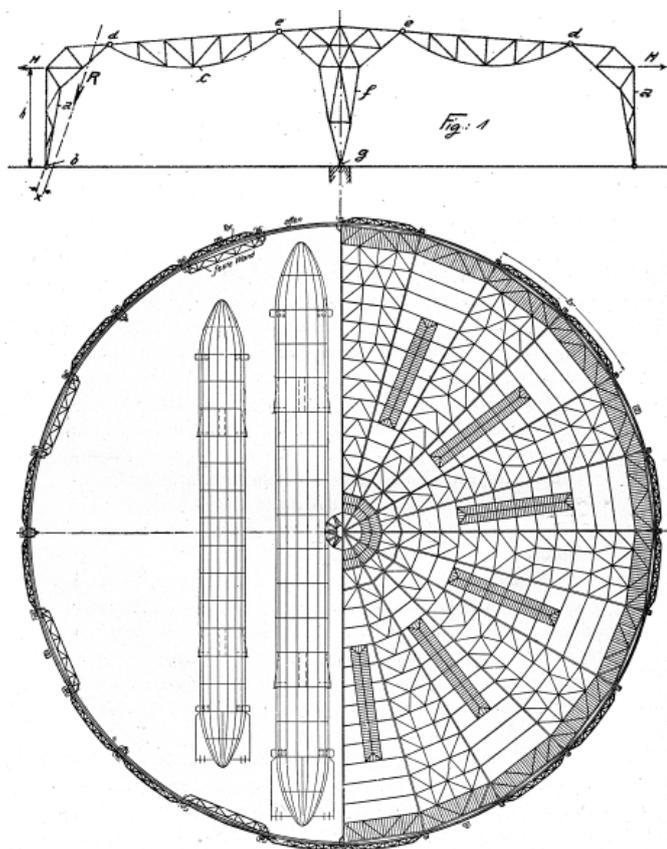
Entwurf einer Rundhalle für Luftschiffe, 1909
